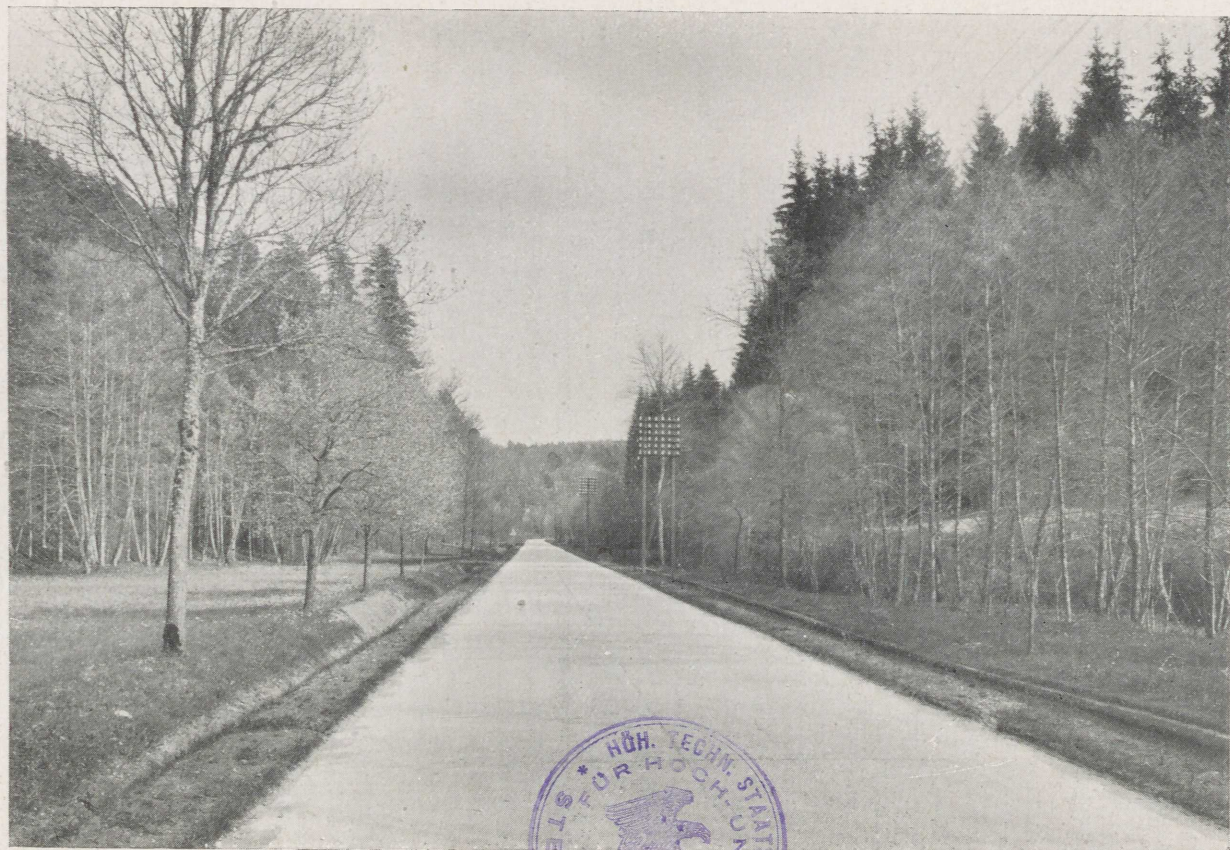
Stuttgart—Tübingen b. Bebenhausen. Auf.: Ludwig Bauer, Stuttgart
